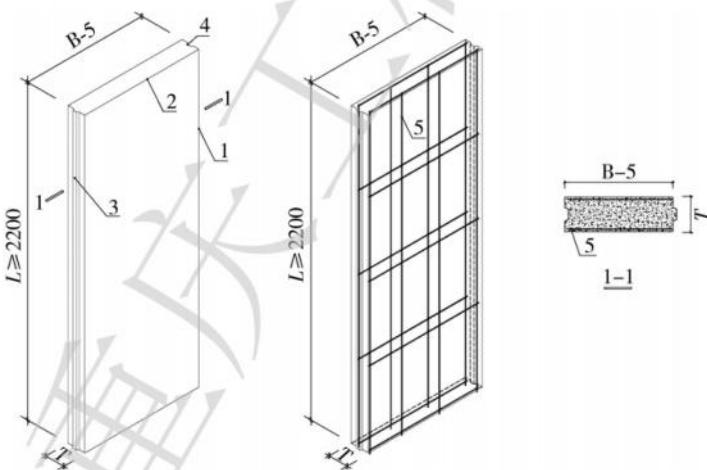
蒸压钢筋陶粒混凝土实心条板构造示意图
